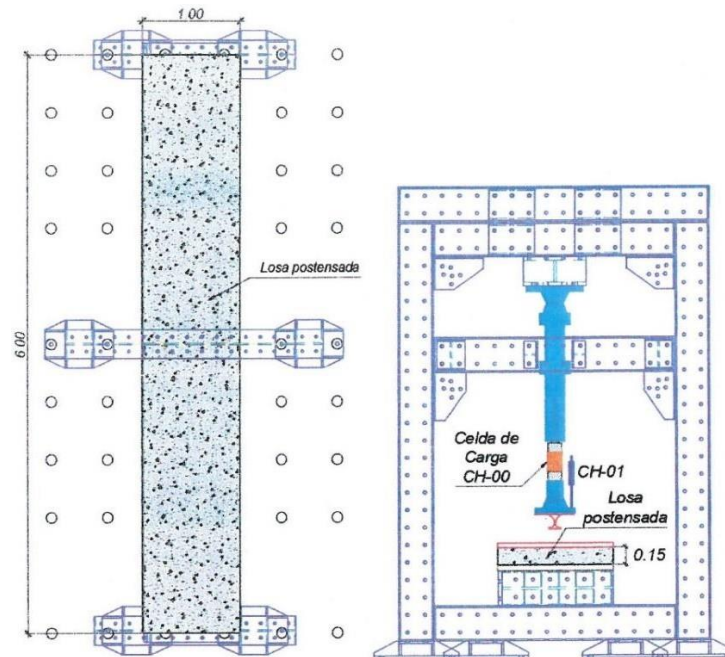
Vista en planta y elevación del mecano de carga y losa postensada.
